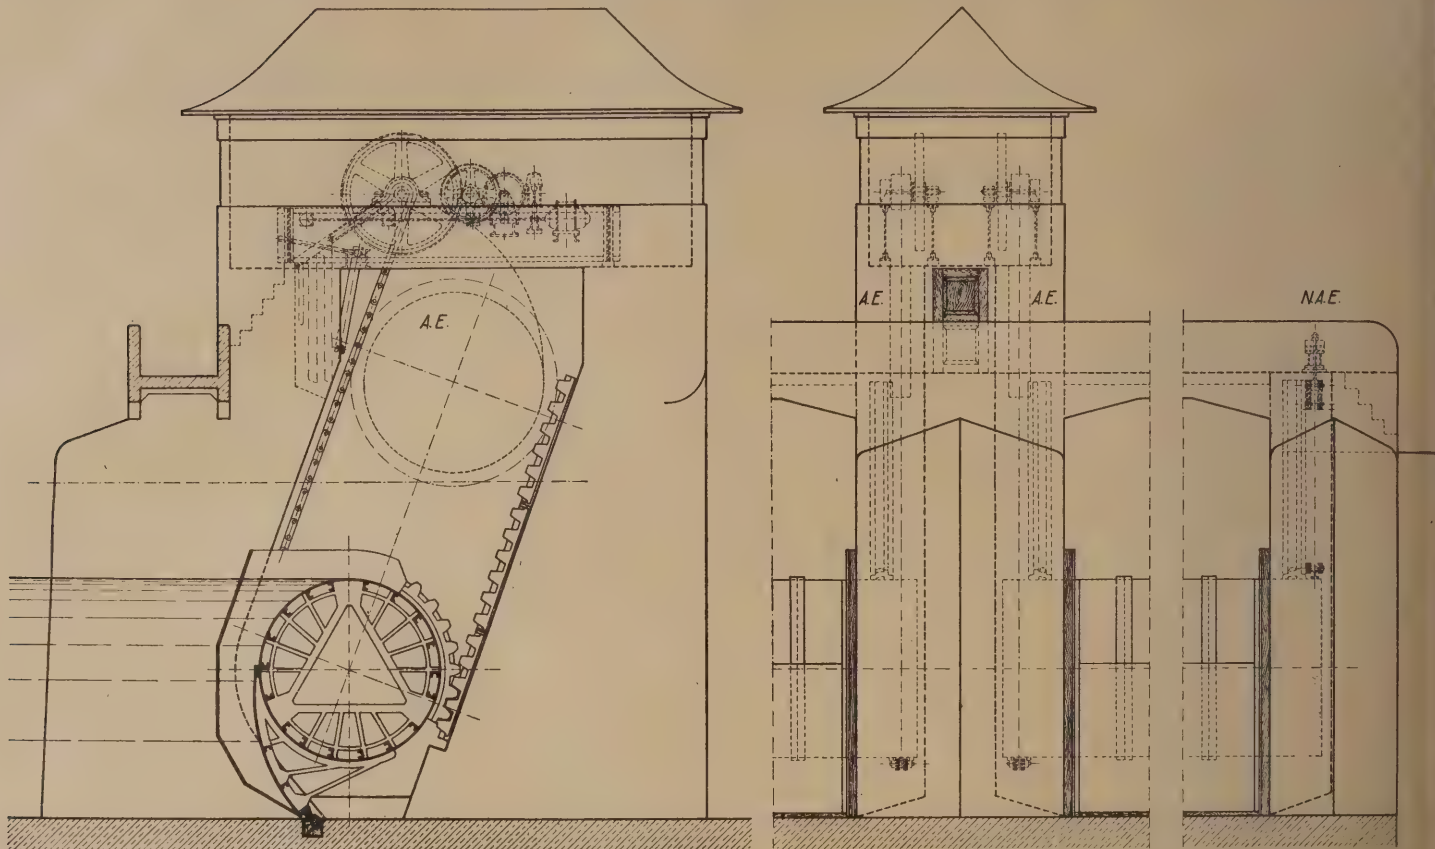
h. Walzenwehr mit normalem Querschnitt.
